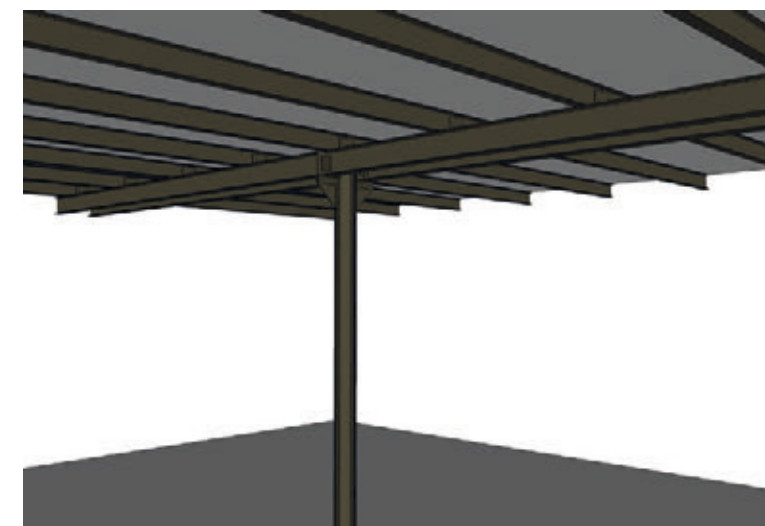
Struttura orizzontale di copertura, in evidenza la struttura primaria e secondaria in travi di ghisa
